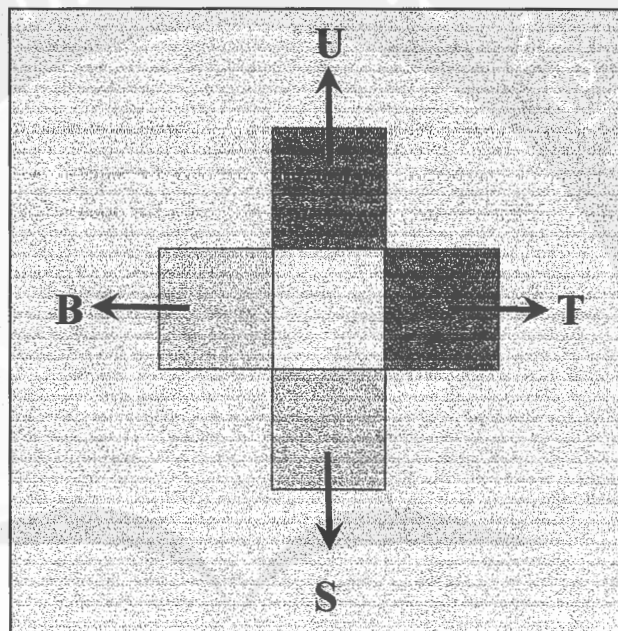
Penataan Massa Bangunan di dalam Site
